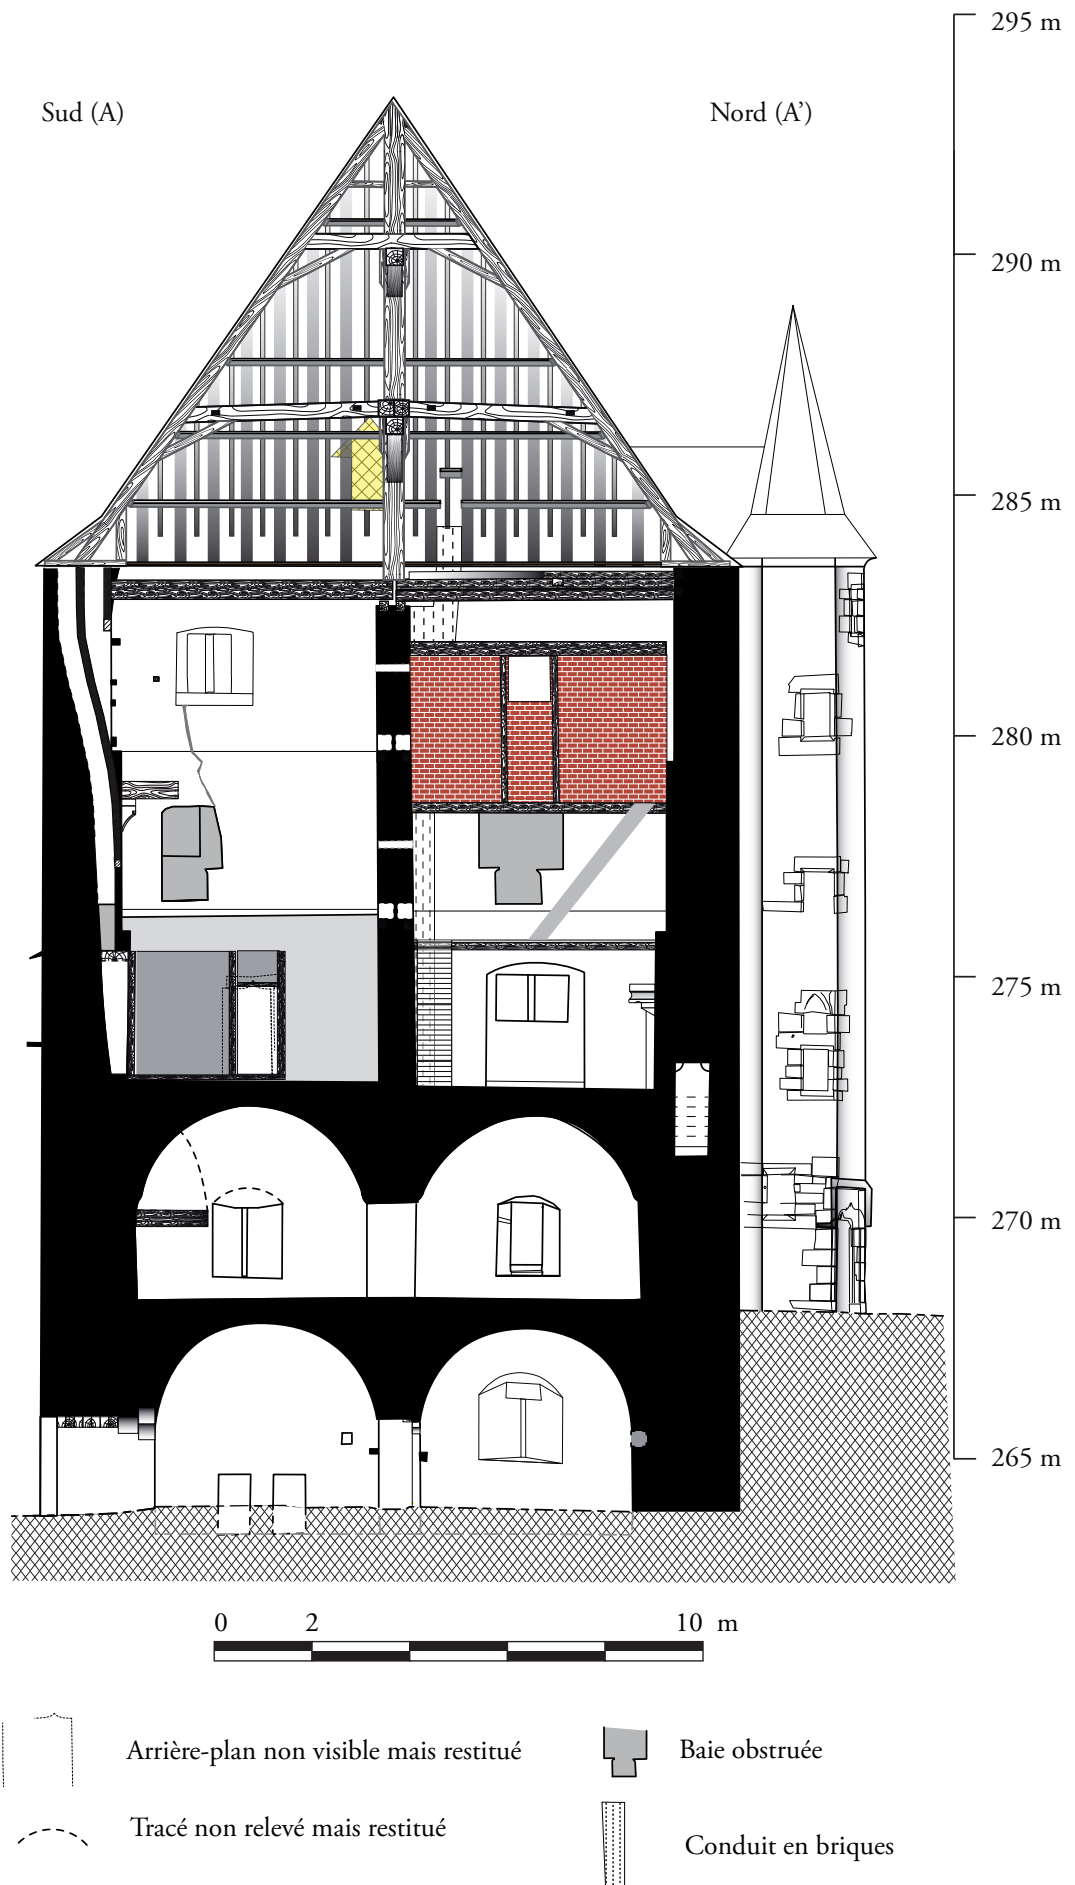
Coupe transversale de la tour, vers l'ouest
